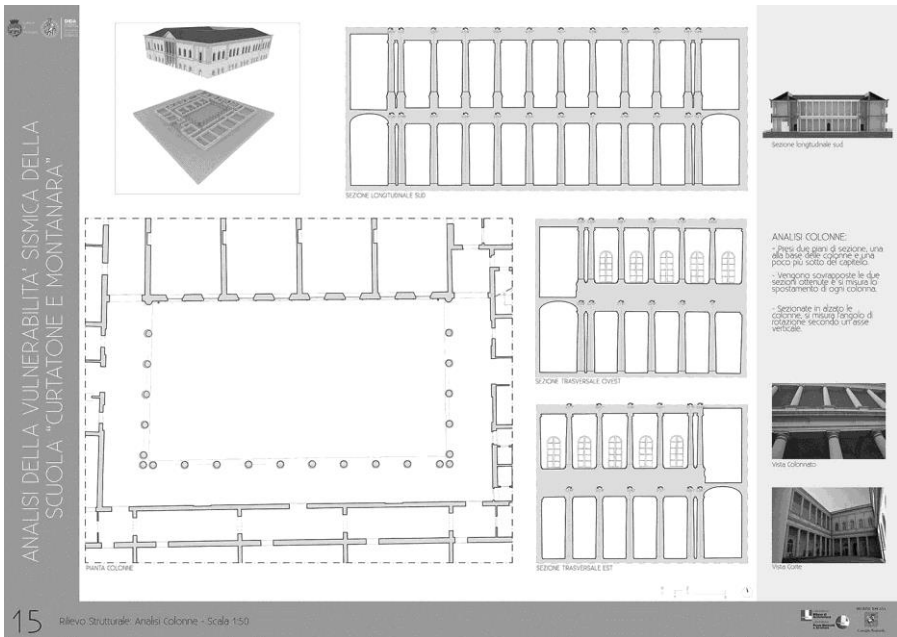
, Pianta piano terra e prospetti, individuazione delle rotazioni del sistema di colonne del cortile.
